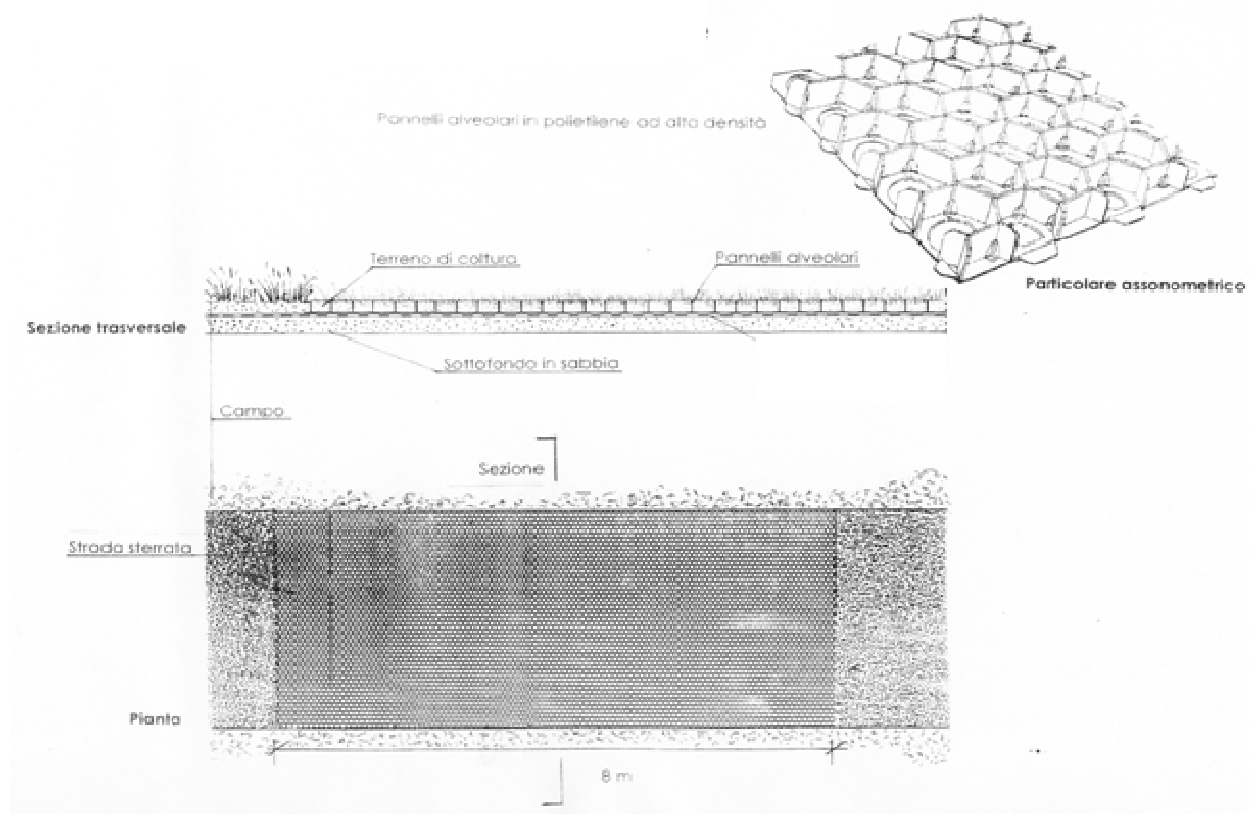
Esempio di attraversamento di una strada campestre con pavimentazione alveolare
